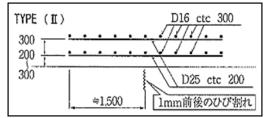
コンクリートダムにおけるひび割れ処置事例 出典:コンクリートダムの施工 (一般財団法人 日本ダム協会)
